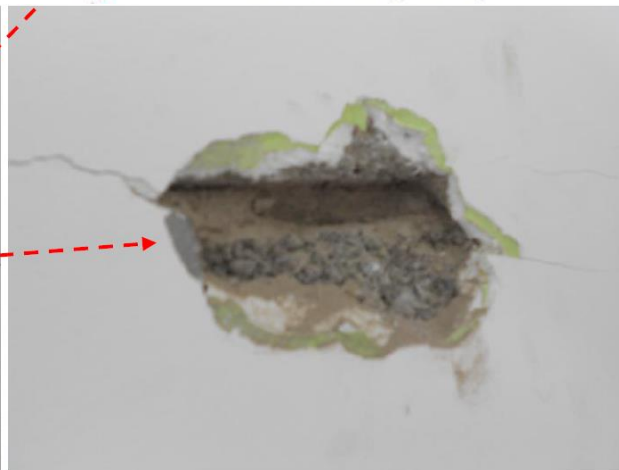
Detalhe 2 da fissuração no quarto.
